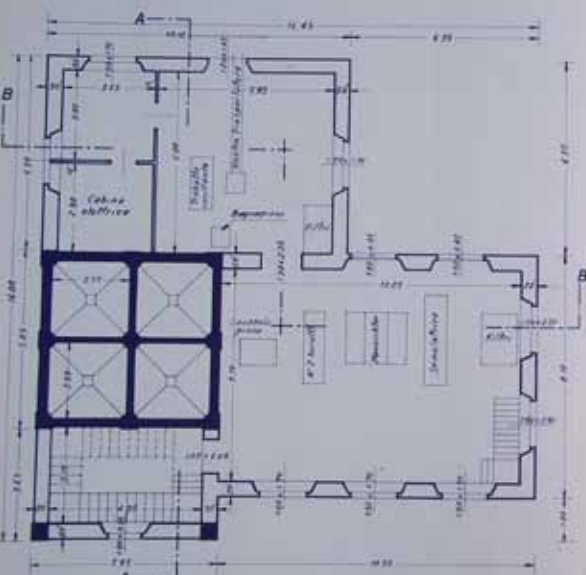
Progetto del molino con silos. Pianta di piano terreno e primo piano.
